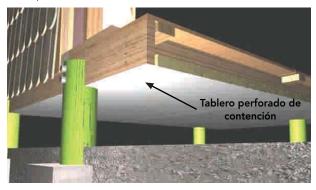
Plataforma de primer piso con aislación térmica. La aislación es sujecionada con tablero perforado para mantener ventilada la estructura.
